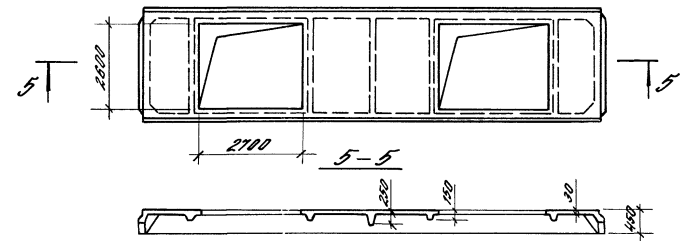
Плита типоразмера 1П12 с двумя проемами для зенитных фонарей
